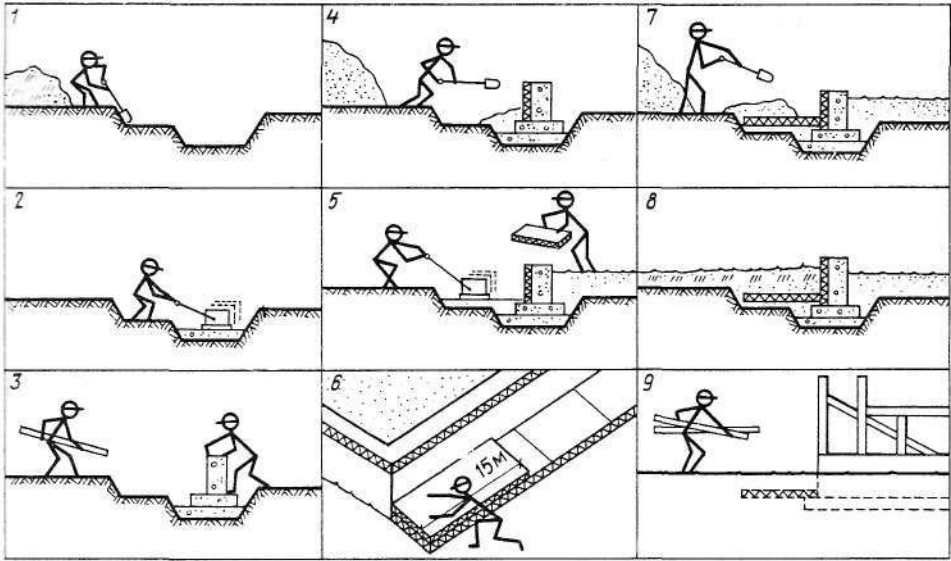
Стадии выполнения работ по устройству и утеплению фундаментов. Лучше всего работы по укладке теплоизоляции начинать сразу же после подготовки основания фундамента
